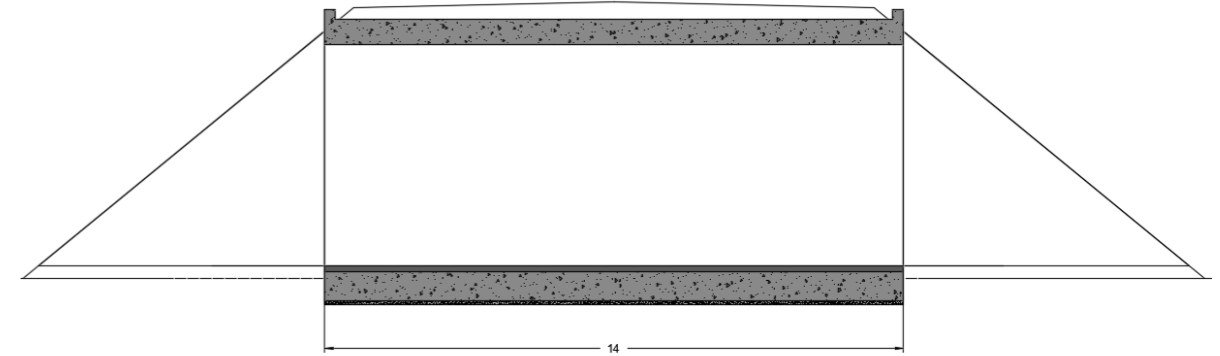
Sección longitudinal de cajón proyectado para paso rodado.
